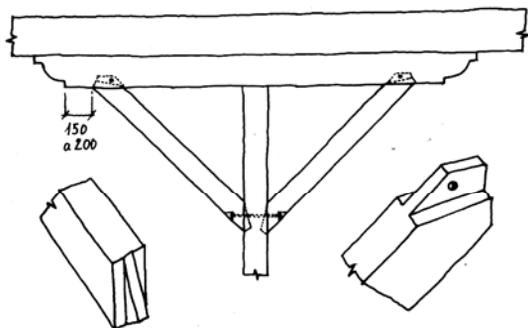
Apoyo de viga sobre pilar con zapata y tornapuntas.
